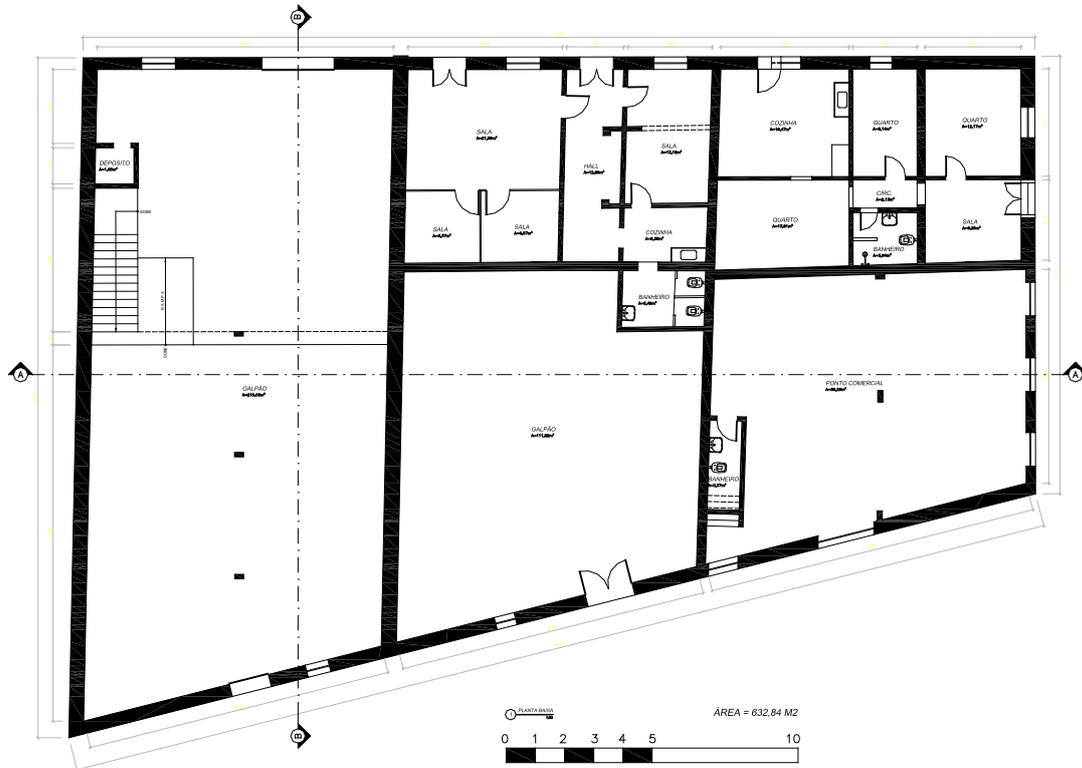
Planta pavimento térreo - Galpão Família Carvalho
